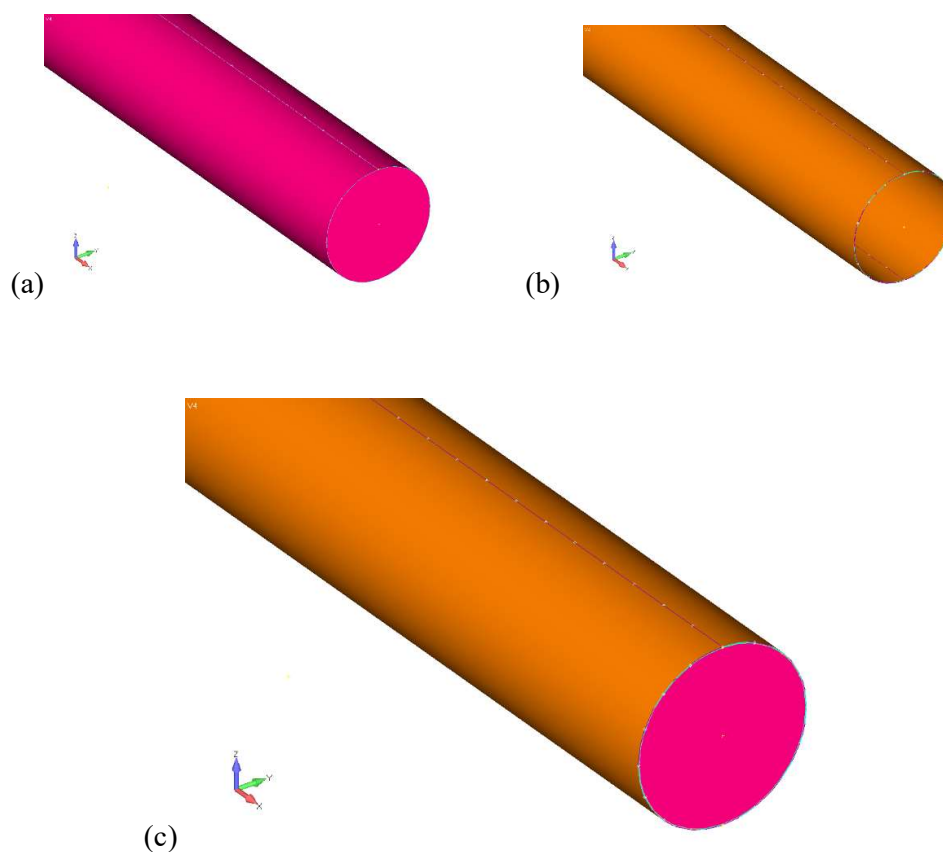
(a) Prikaz geometrije modela betona; (b) modela uzdužne i poprečne armature
